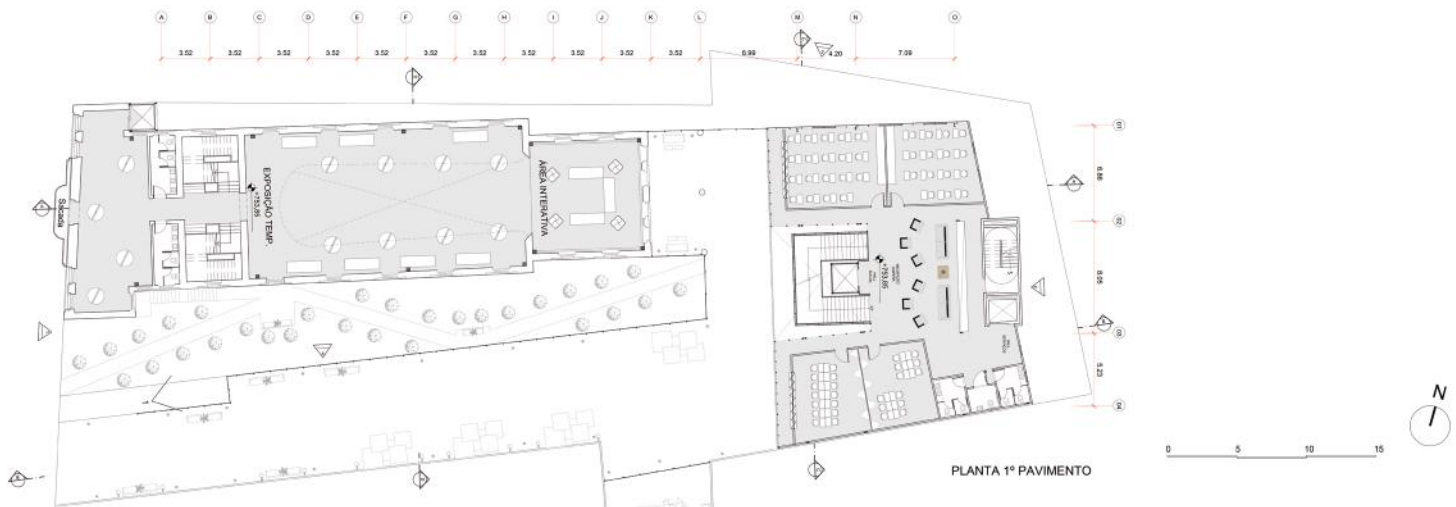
Planta 1o pavimento | Projeto de Laís Paraizo, 2019.
